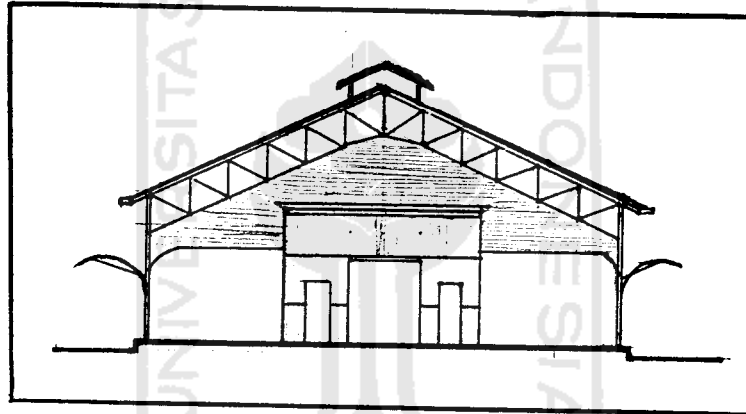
Penataan ruang dan bangunan MKAA.
